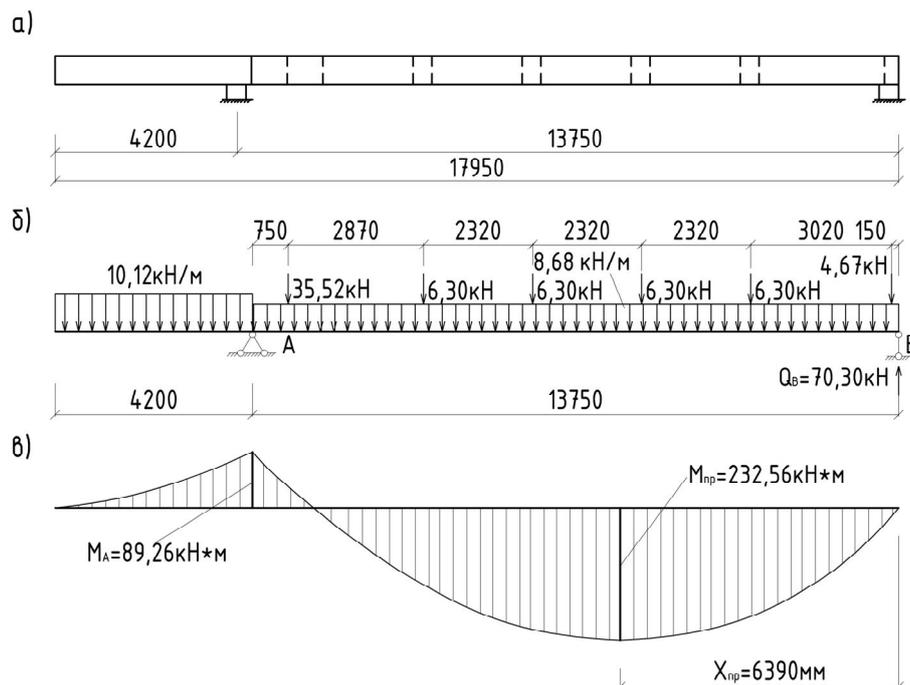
К расчету крайней колонны в стадии монтажа
